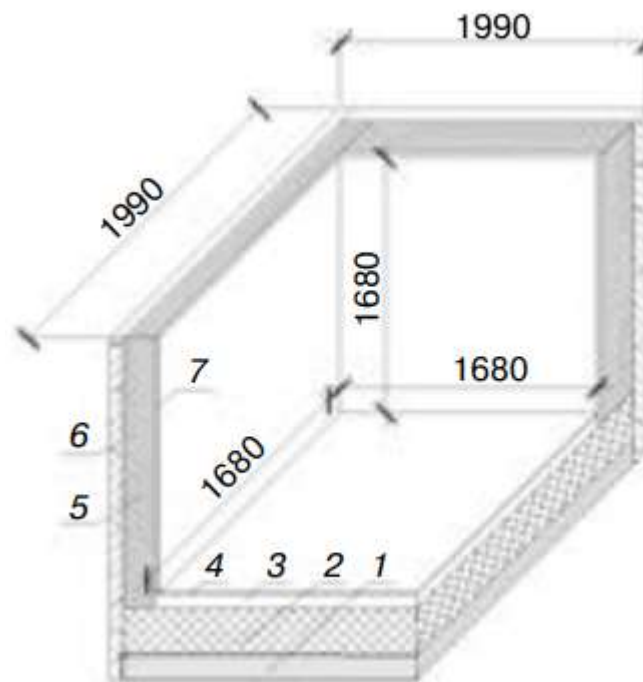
Просторовий фрагмент огородження: 1 – монолітне залізобетонне перекриття; 2 - утеплювач з пінополістиролу; 3 – цементно-піщана стяжка; 4 – лінолеум; 5 – утеплювач стіни з пінополістиролу; 6 – залізобетонна панель; 7 – штукатурка з цементно-піщаного розчину по сітці, натягнутою на конекторах
